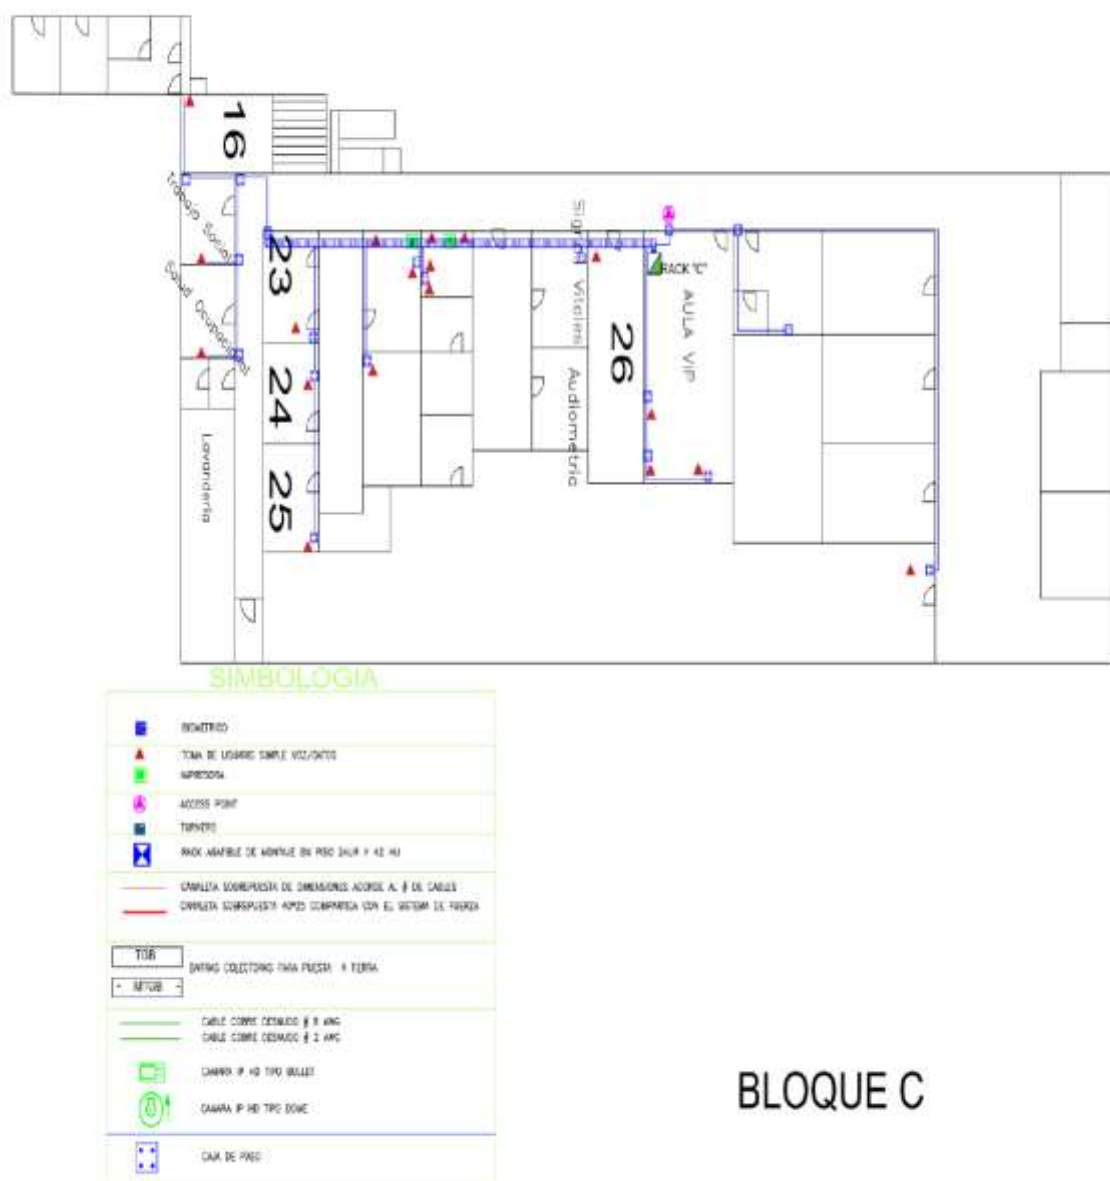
Bloque C, recorrido bandeja metálica y tubería EMT.
